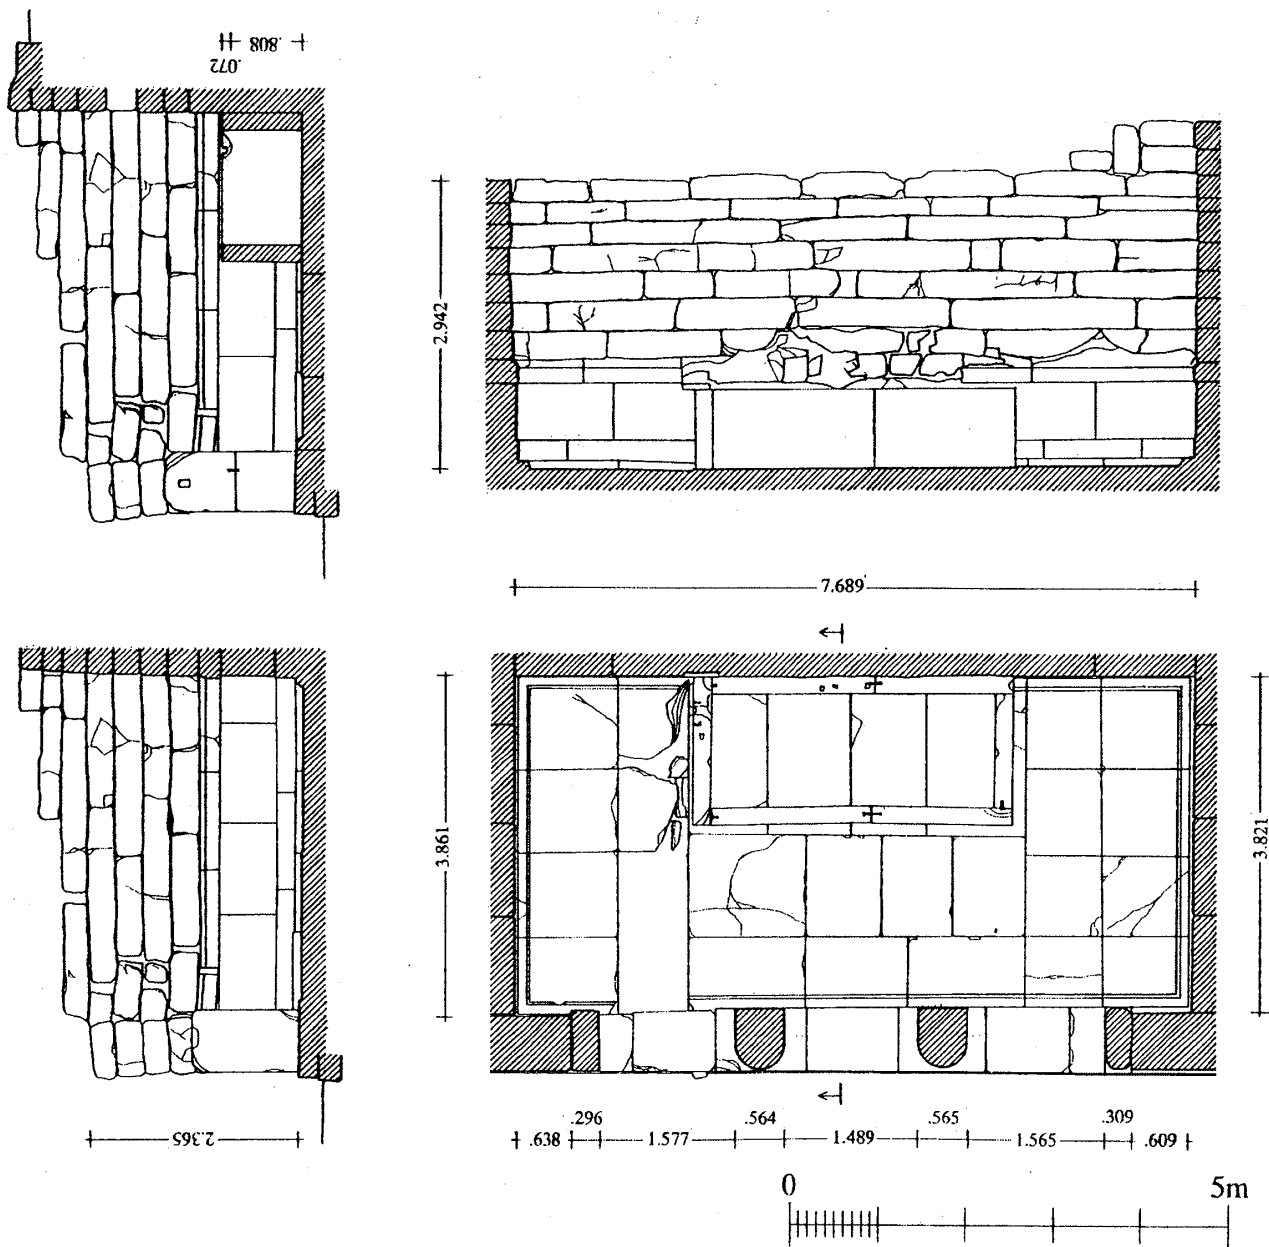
ファウンテン平面図・西面及び北面内部立面図・南北断面図
